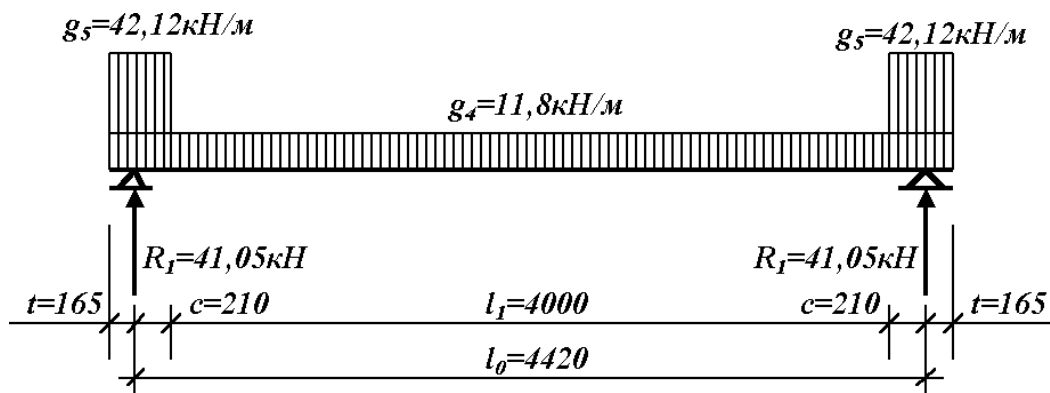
Розрахункова схема фундаментної балки для першого випадку завантаження
